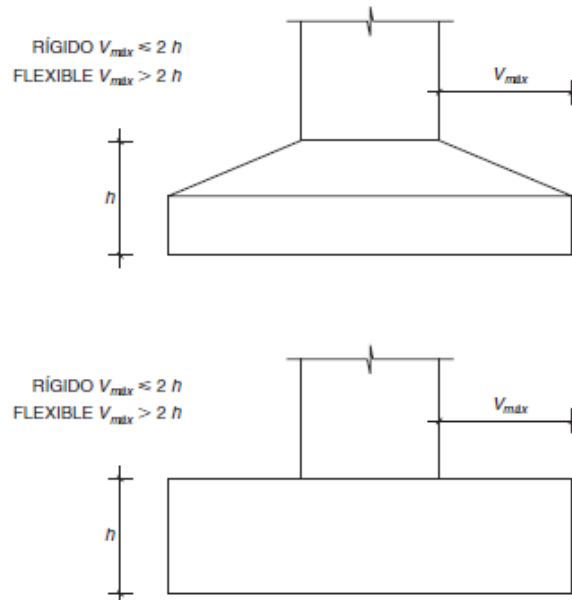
Condiciones de zapata rígida y flexible. (Figura 58.2.1.b EHE-08)
